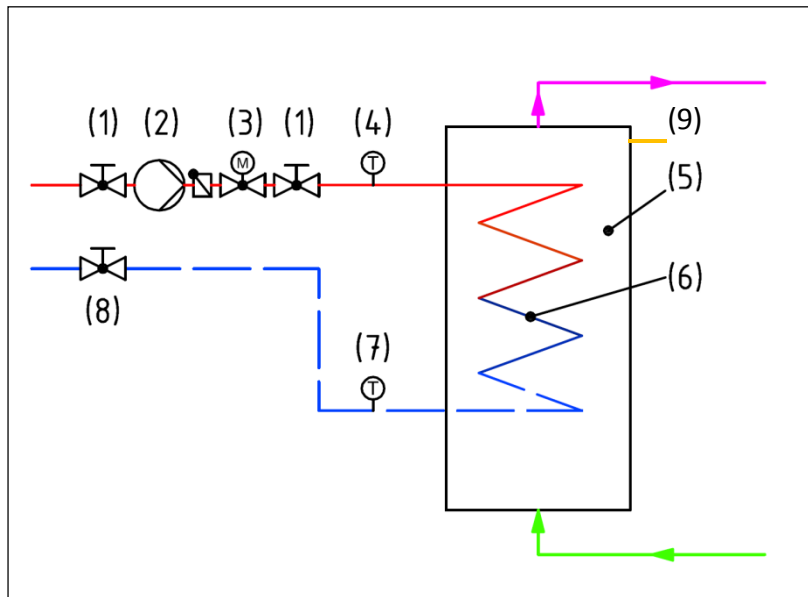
Brauchwasserbereitung mit Warmwasserspeicher
